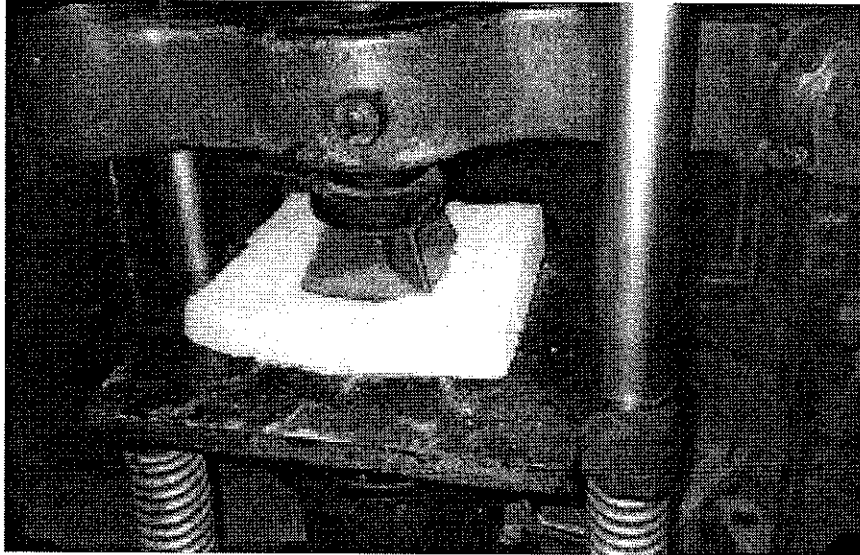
Muestra la falla por corte punzonante y flexión producidas al centro y a las orillas de la tapadera debido a la carga aplicada.
